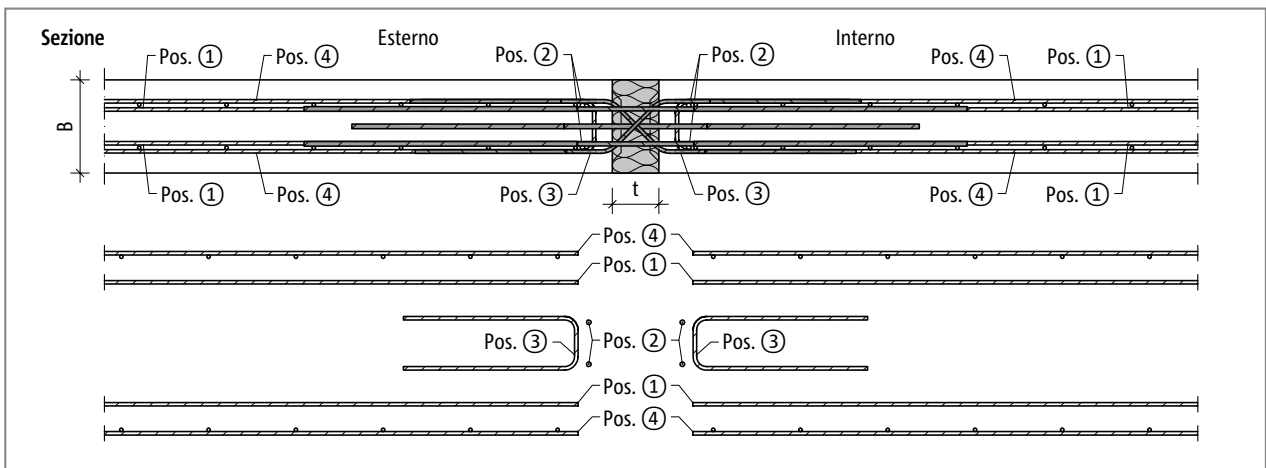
Schöck Isokorb® tipo W, pianta dell'armatura in opera
